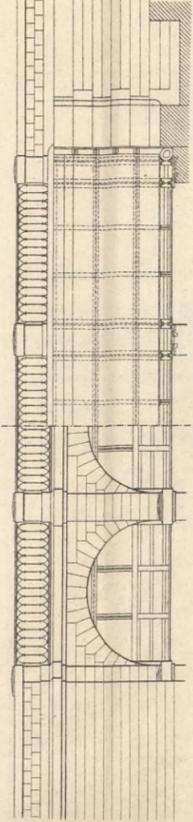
Grundriss der Eisenconstruction. Plan view of the iron construction, showing the layout of the iron frame.
